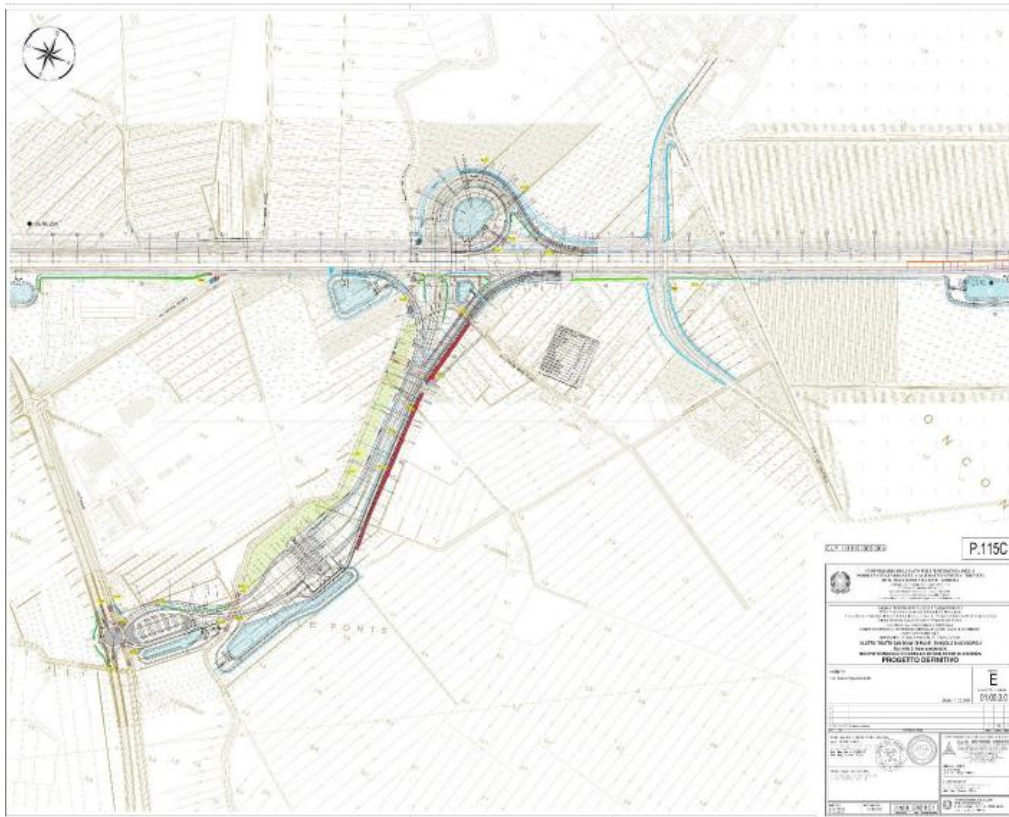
Estratto dalla planimetria di progetto del nuovo svincolo (elab. E.01.00.0.0)
